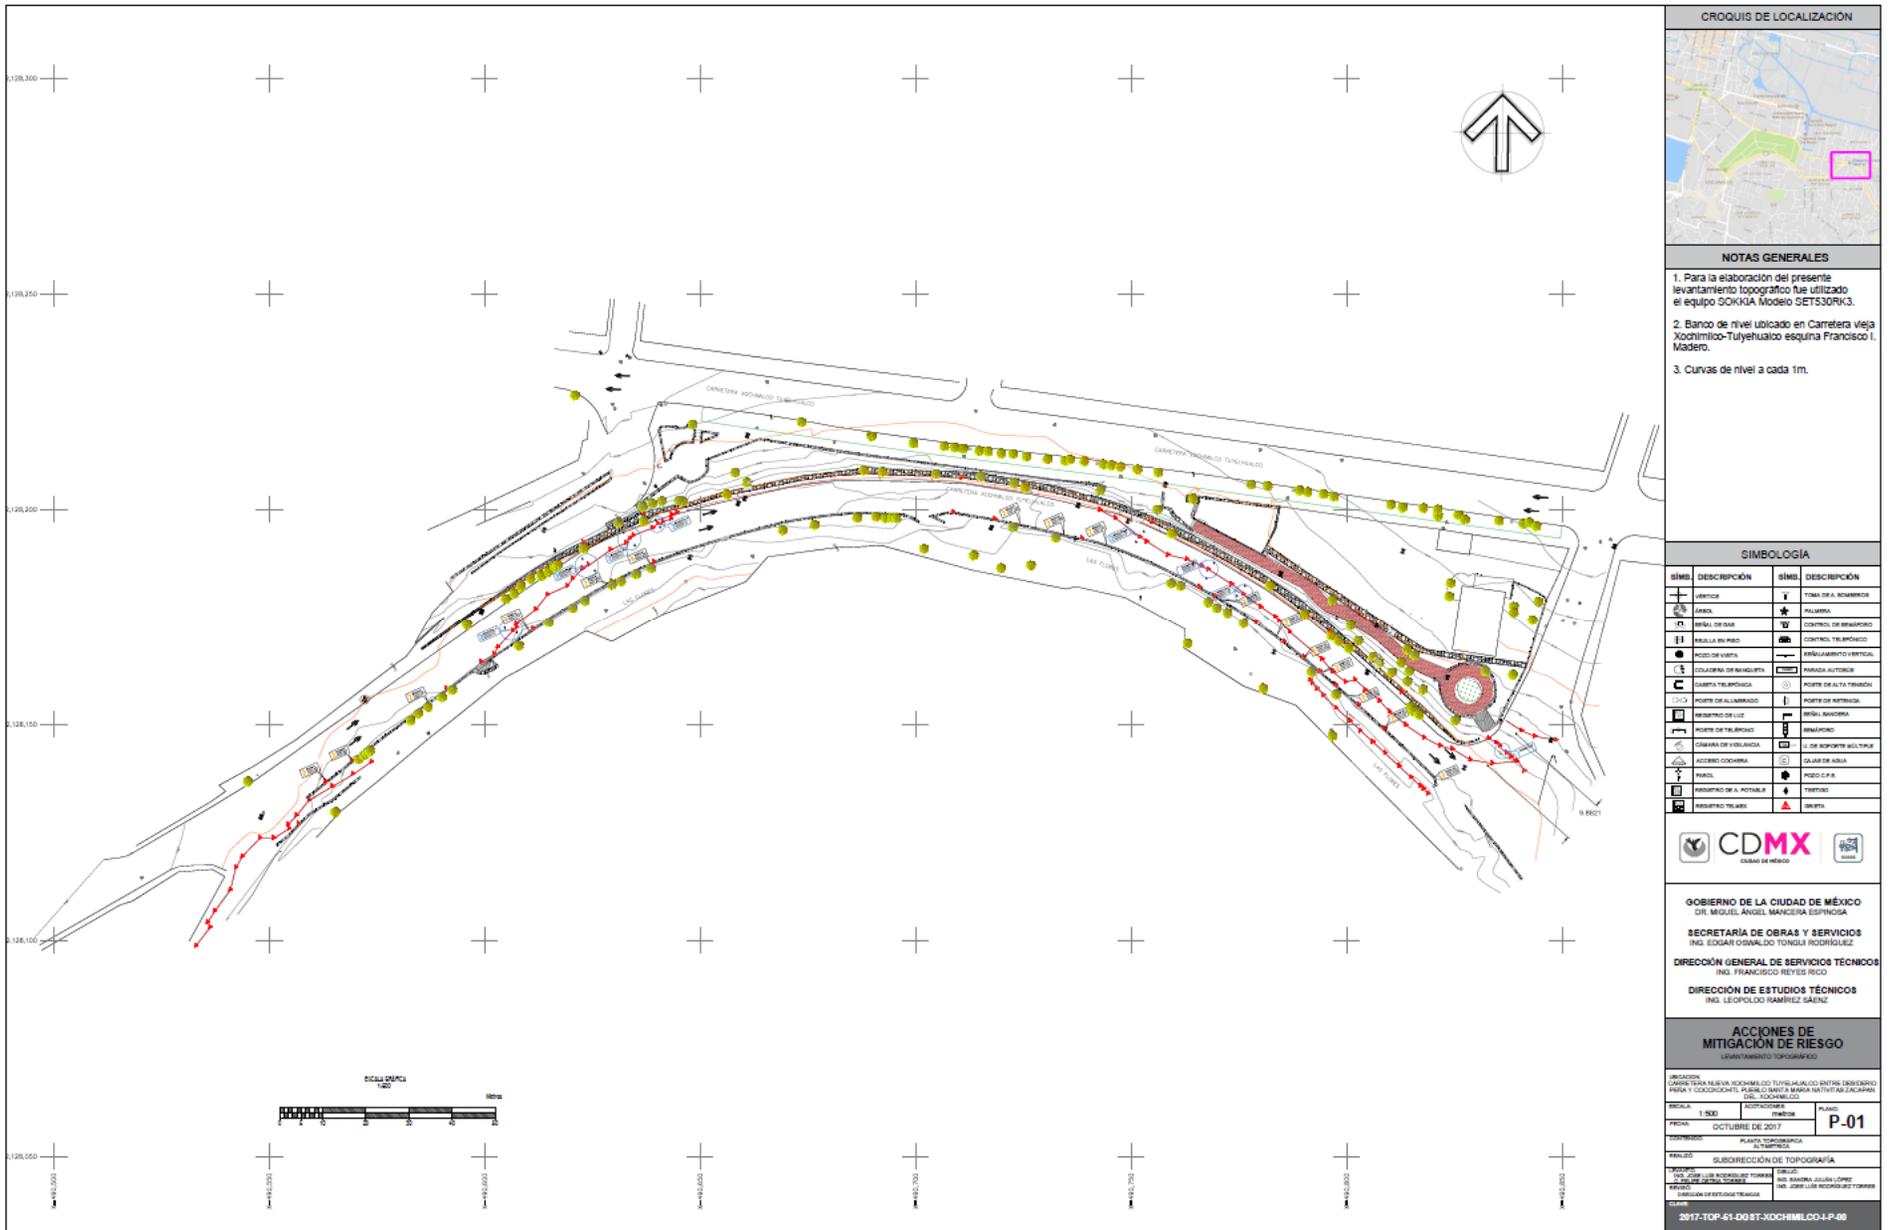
Plano Topográfico Fallas en pavimento escala 1:250.
